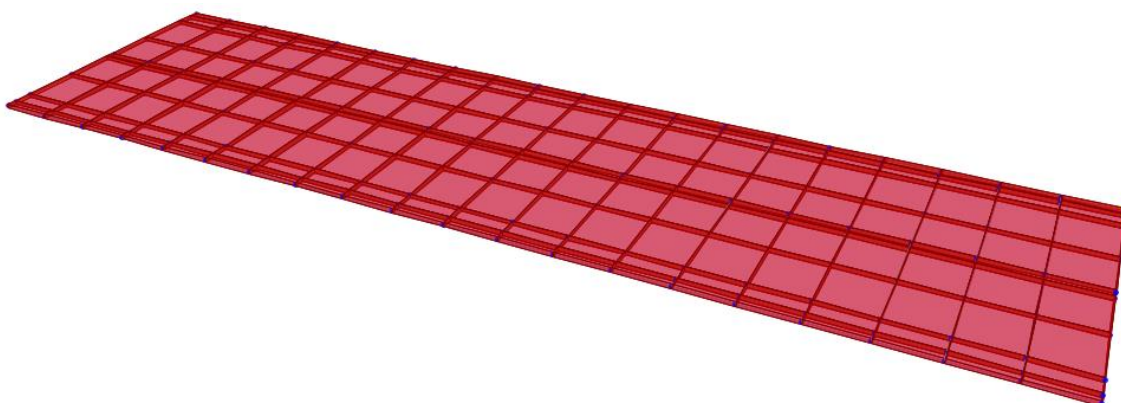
Vista extruida de los elementos shell con las propiedades del tablero asignadas
